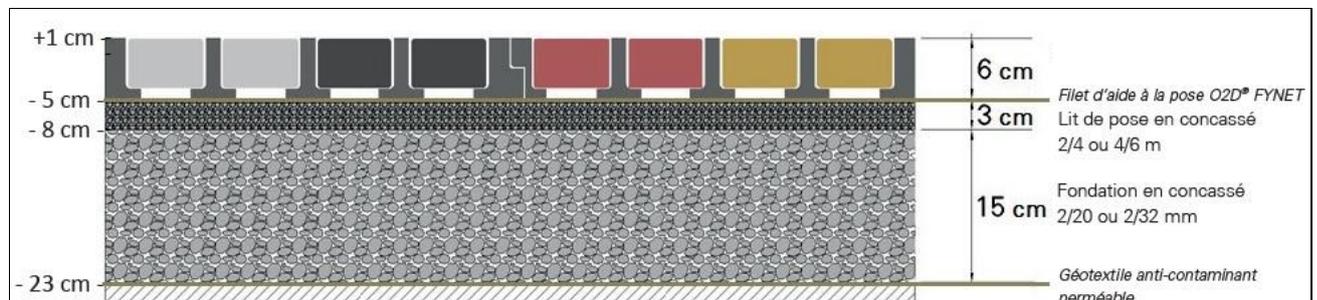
Principe de mise en œuvre des dalles pavées infiltrantes
